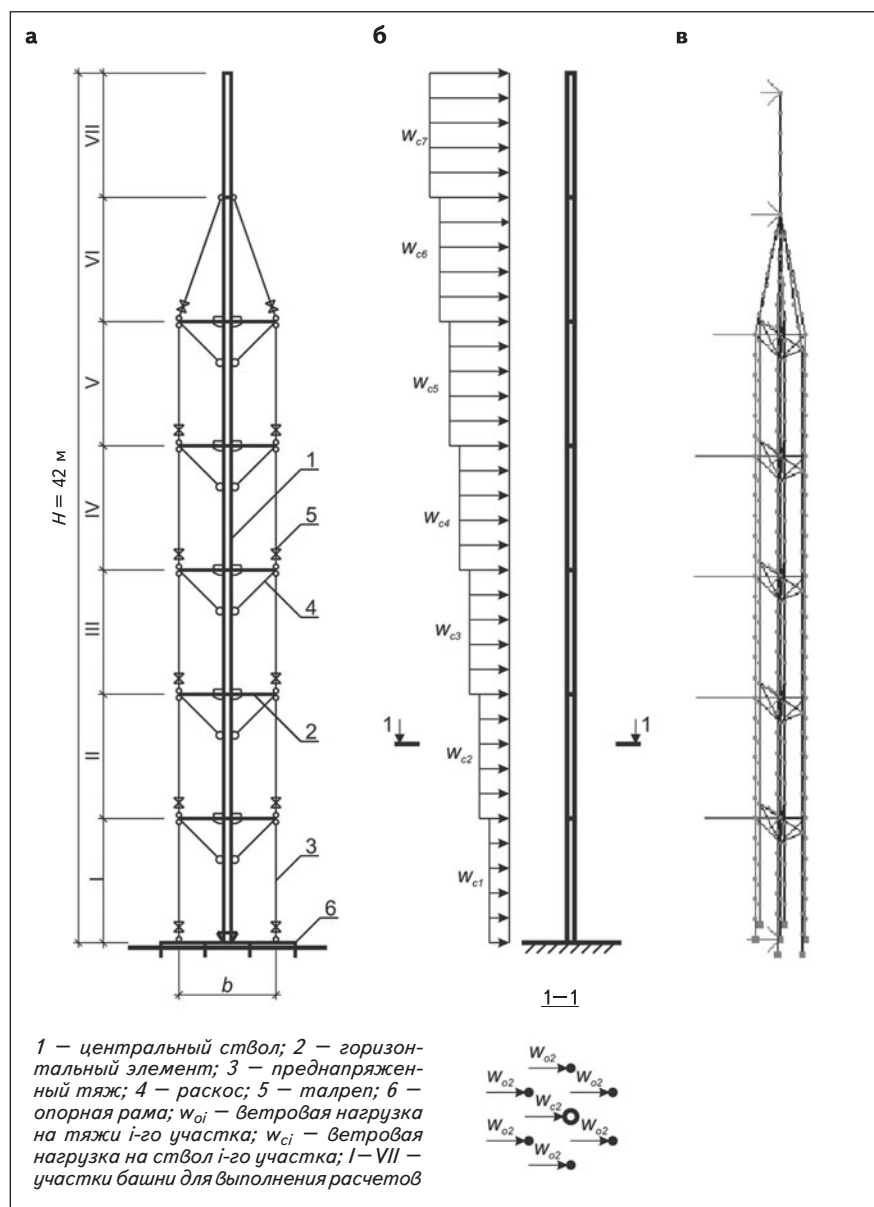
Конструктивная схема башни (а), распределение ветровой нагрузки по ее высоте (б) и схема приложения ветровой нагрузки к расчетной схеме в ПК «ЛИРА-САПР» (в). На схеме б башня показана условно, без тязей и площадок
